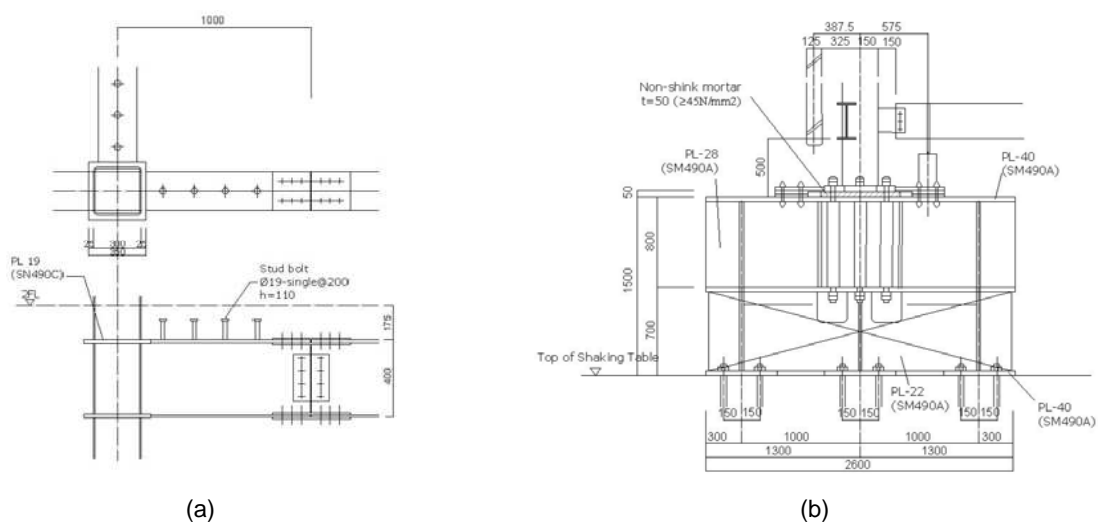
Ligação Viga Pilar (a) e ligação de encastramento por chapa de base (b)
